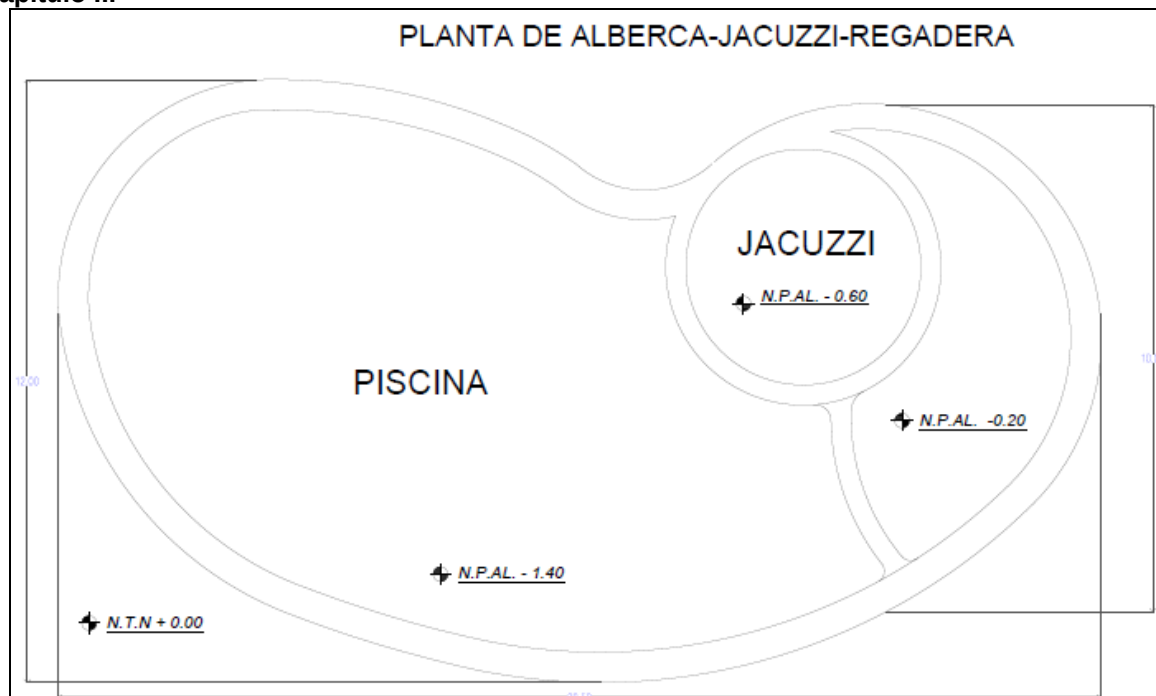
Dimensiones del área de alberca y jacuzzi. Ver detalles en Plano 7.
